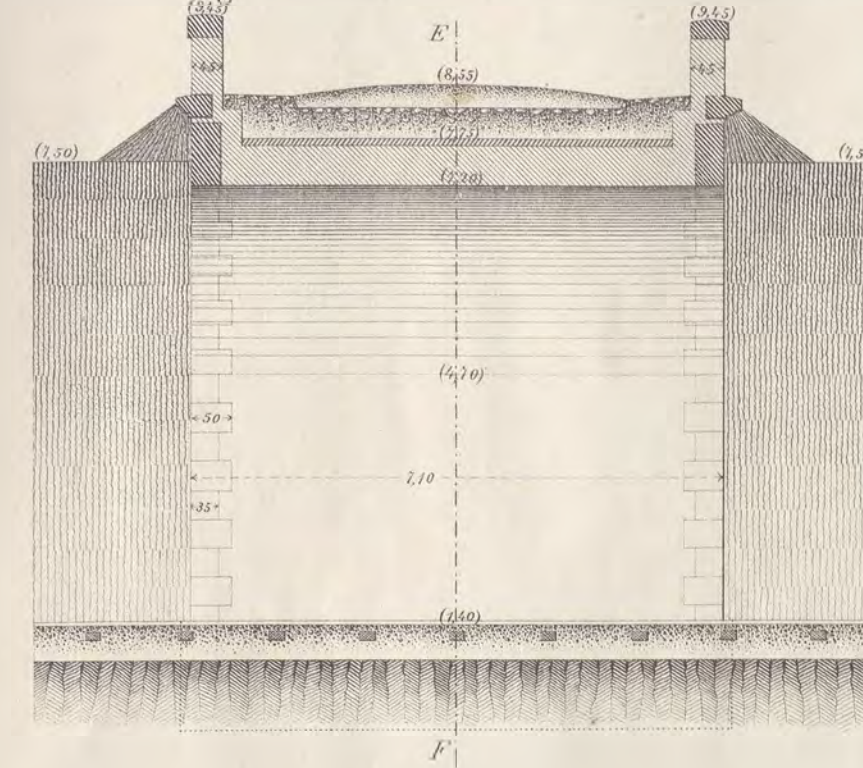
<sup>a</sup> Prospetto e sezione longitudinale *EF*.
